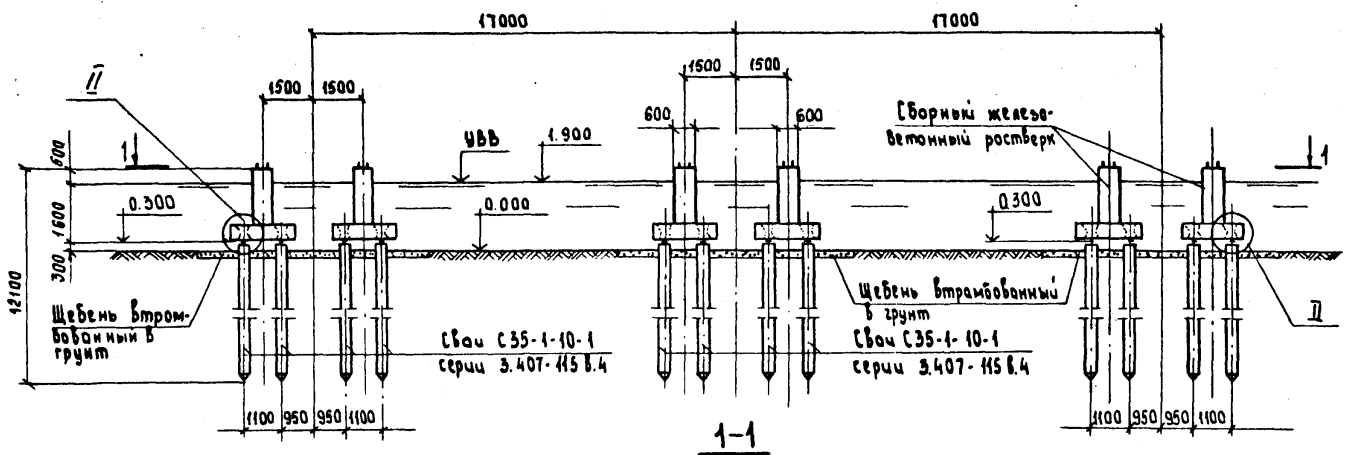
Одностваяная конструкция, единая под опору. Вариант установки на монолитный железобетонный ростверк.
